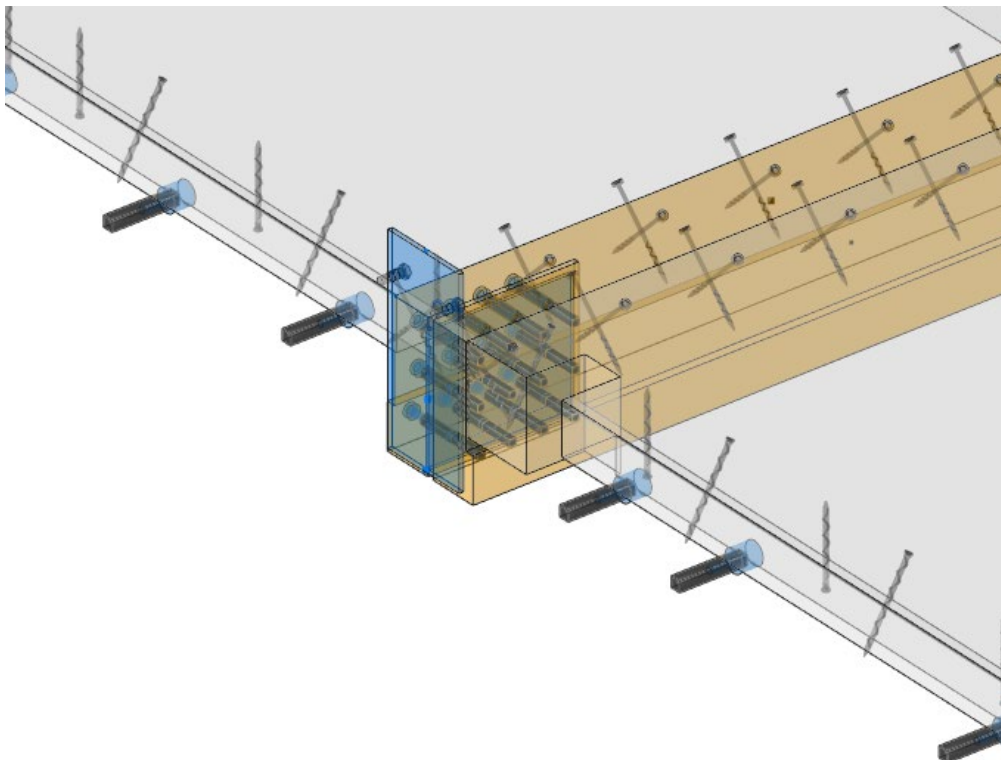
Detailausschnitt CADWORK-Modell Stahlschuh an Beton
